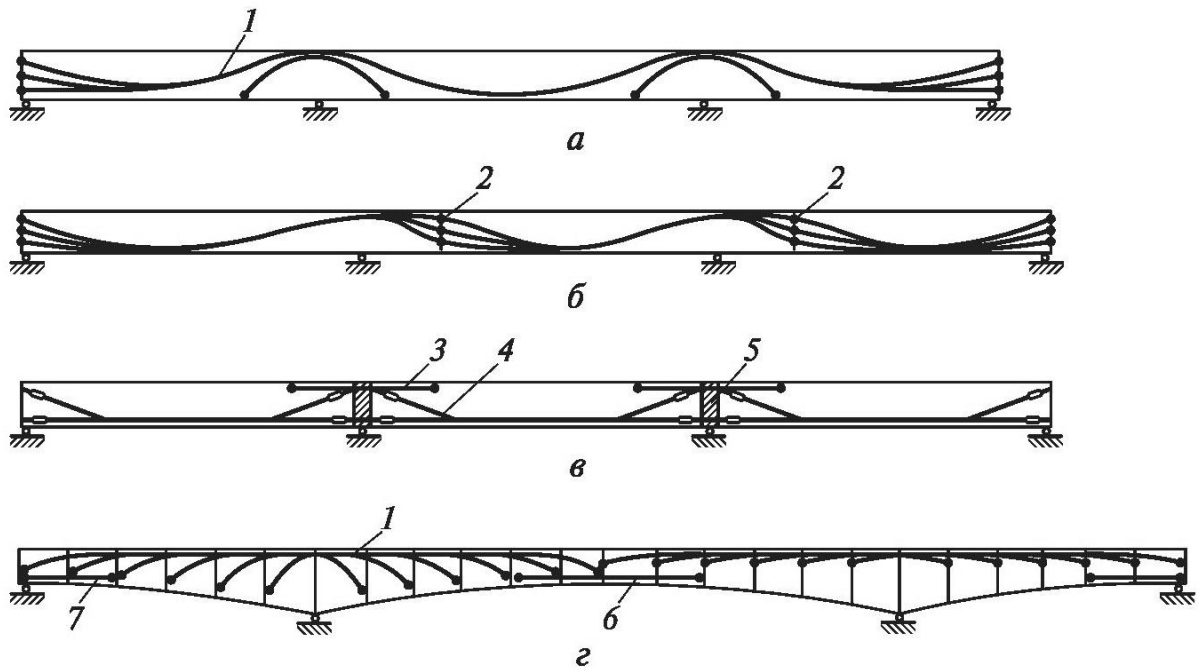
Варианты схем (а-г) армирования напрягаемой арматурой:
